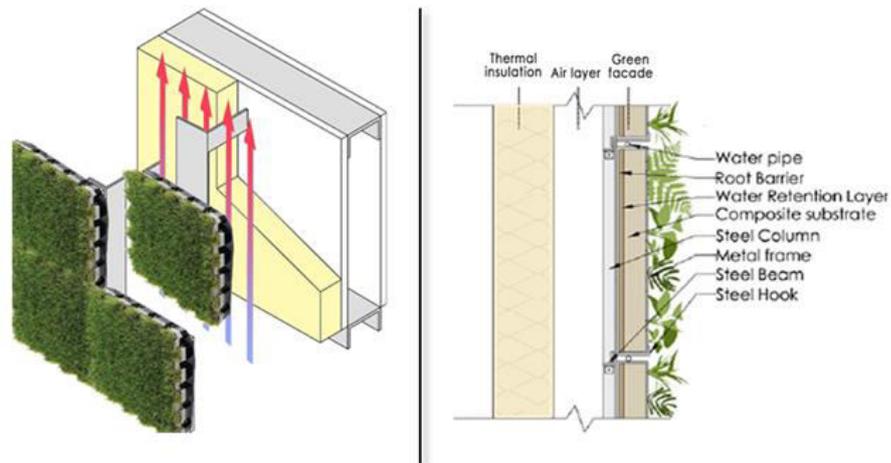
La porzione verde ventilata (ascissa da 4.5 a 9.0 m), esposta ad est
